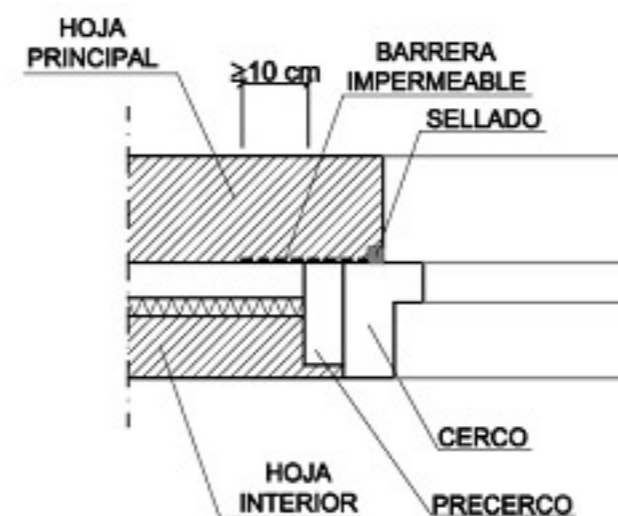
Ejemplo de encuentro de la fachada con la carpintería
